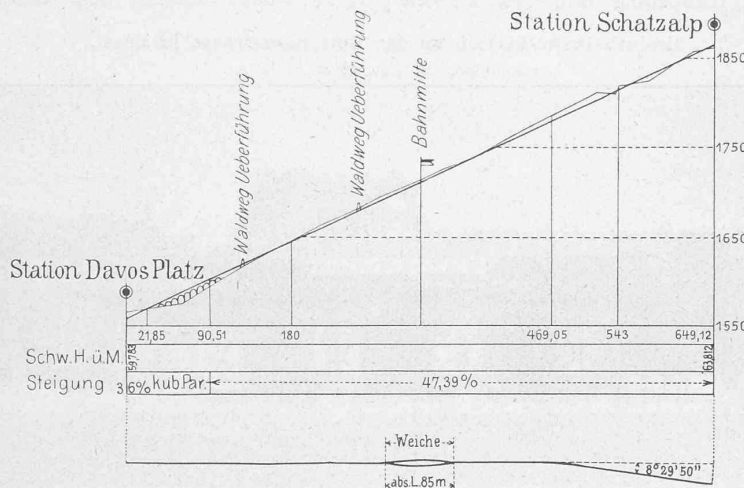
Längenprofil und Lageplan. — Masstab 1:7500.
